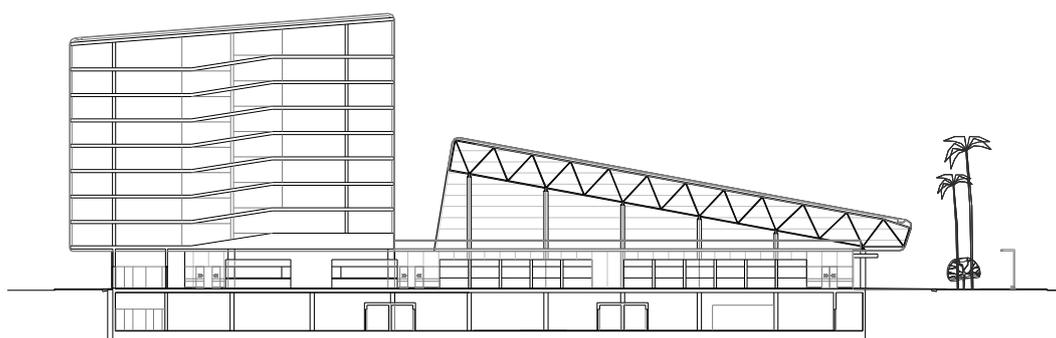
Segundo proyecto del Mercado de la Pescadería.
